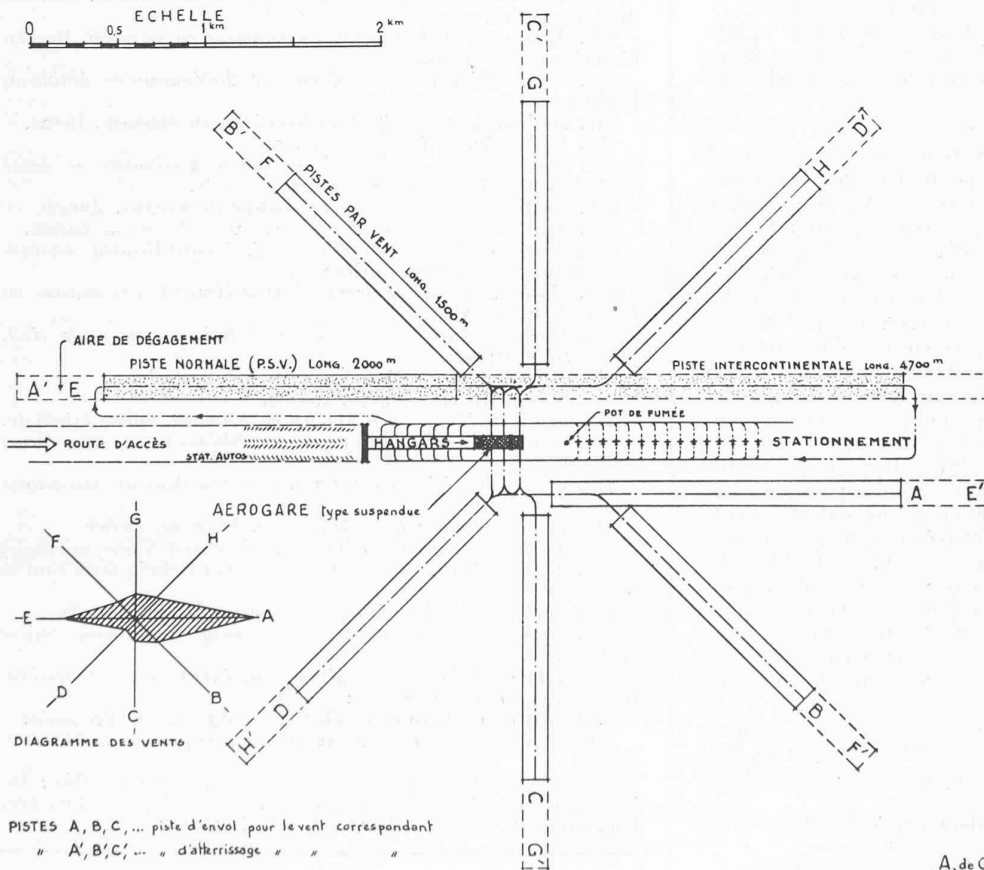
Exemple d'aéroport type basé sur le système de la double piste avec gare centrale. Cet exemple avec une piste donnerait un débit de pointe de 60 avions horaire. Accès à l'aérogare du type suspendue par le toit des hangars (la gare se trouvant en fait à l'autre extrémité des hangars).
